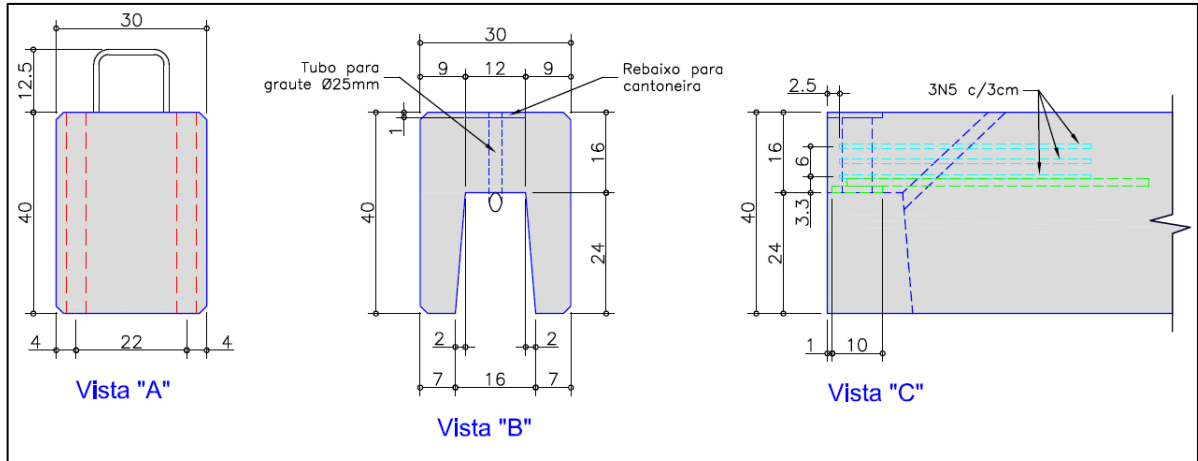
Detalhamento da viga (medidas em centímetros).
